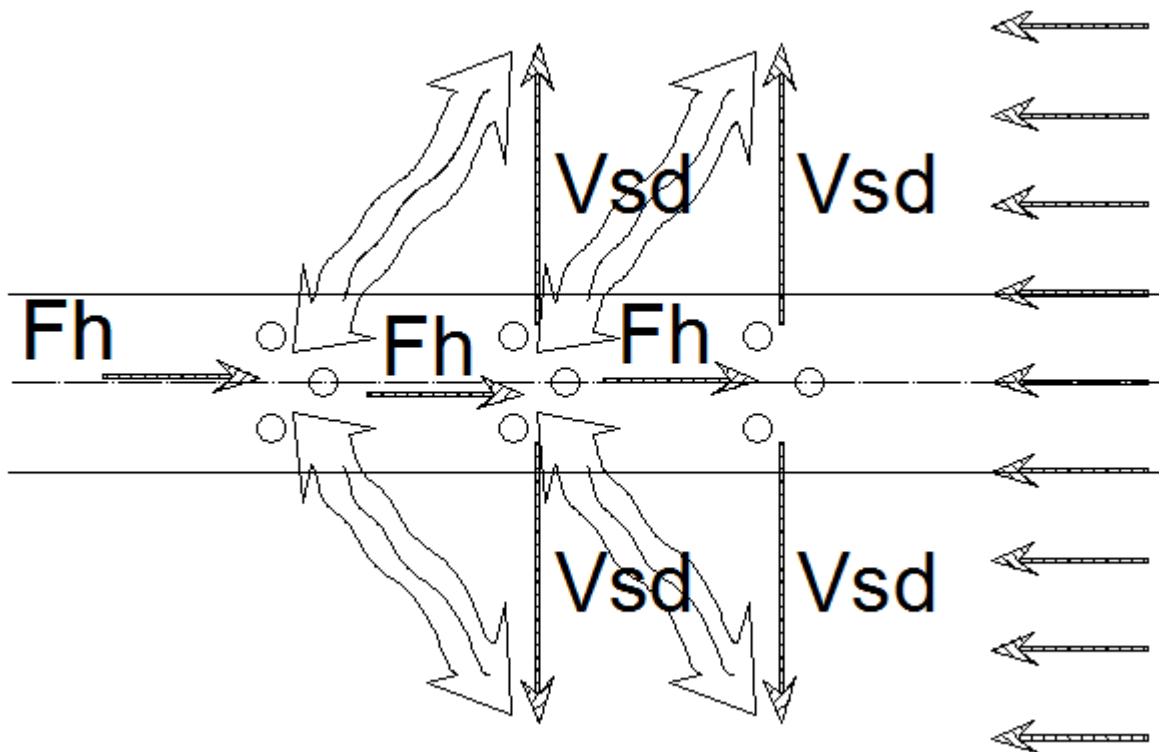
Detalhe em planta do mecanismo de mobilização da compressão na laje
